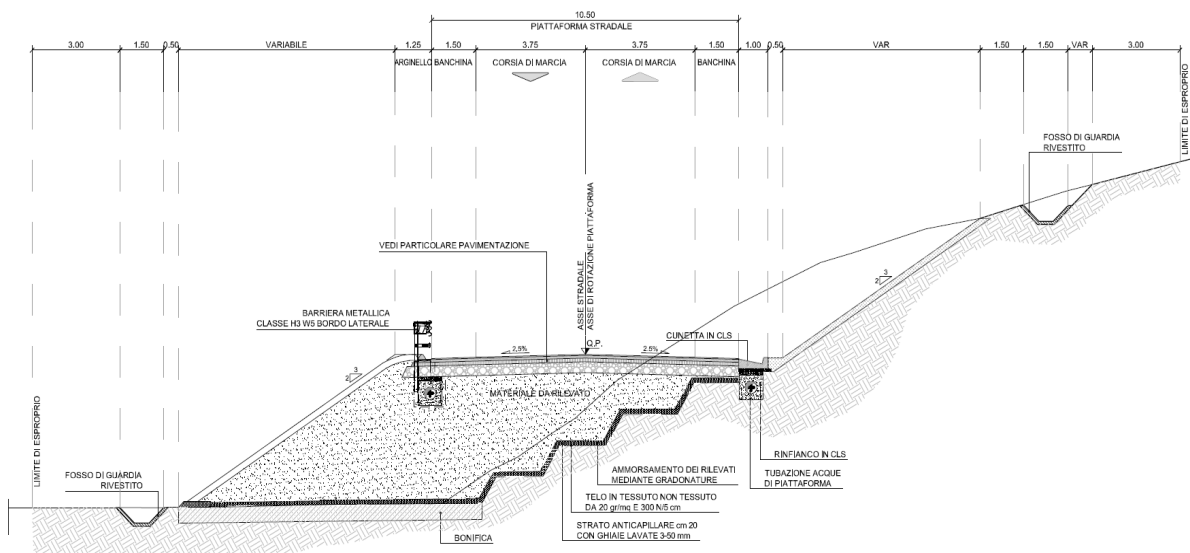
Sezione stradale tipo con interventi per passaggio a mezzacosta
